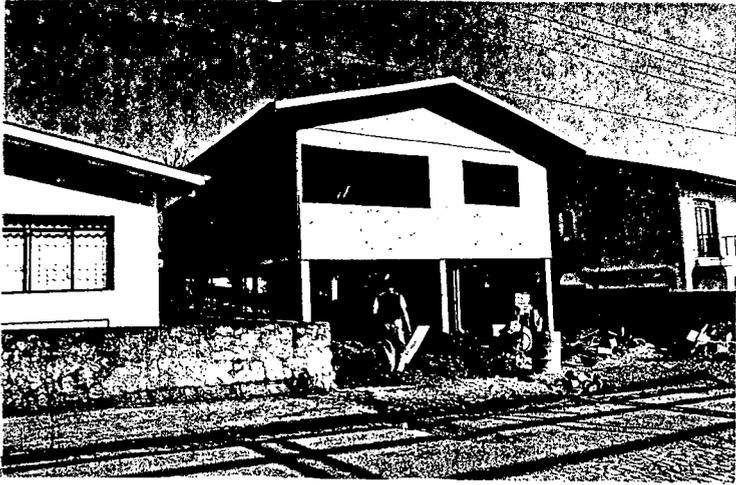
Casa em construção em Cacador. Paredes de tábuas macho-fêmea na vertical, feitas de pinho. Apoiada sobre pilares de concreto.
